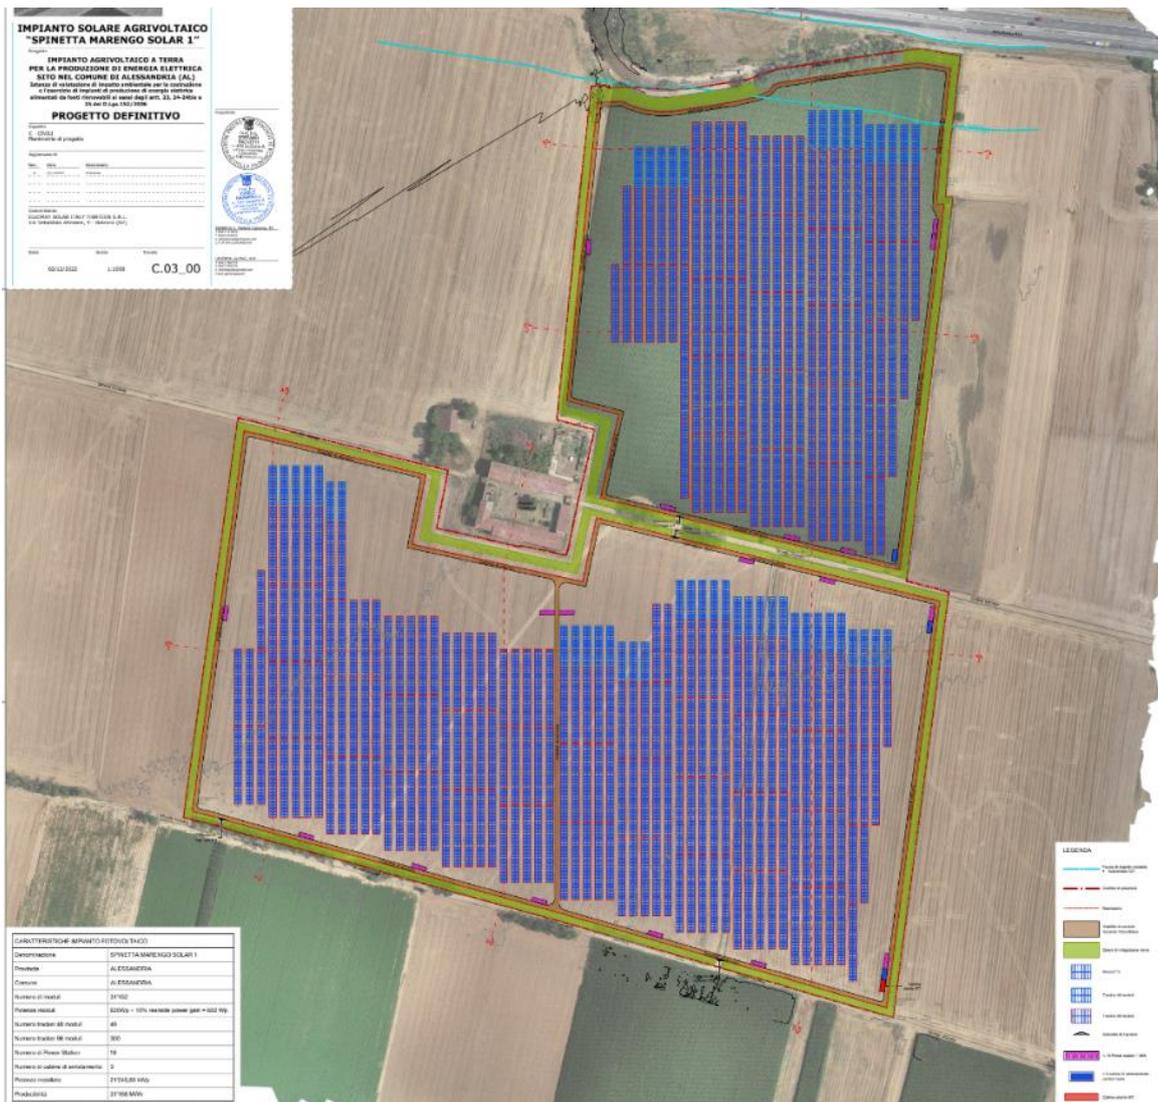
Planimetria di progetto. Tavola C\_03\_00 di progetto
